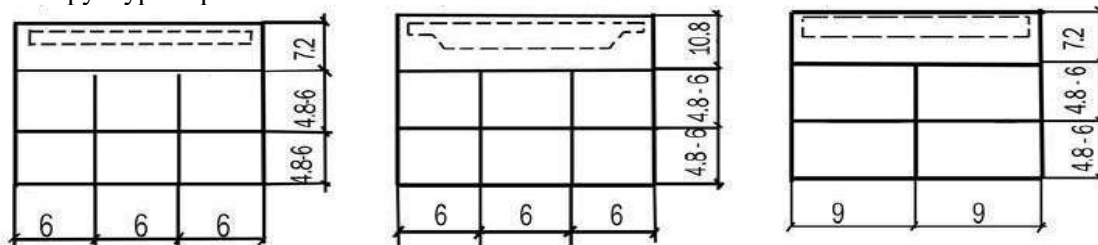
Унифицированные габаритные схемы многоэтажных зданий
